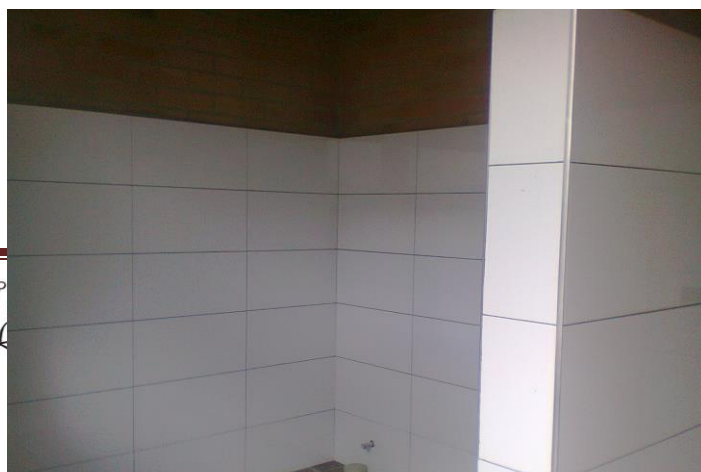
Instalación de Enchape muros (foto de ejemplo)
